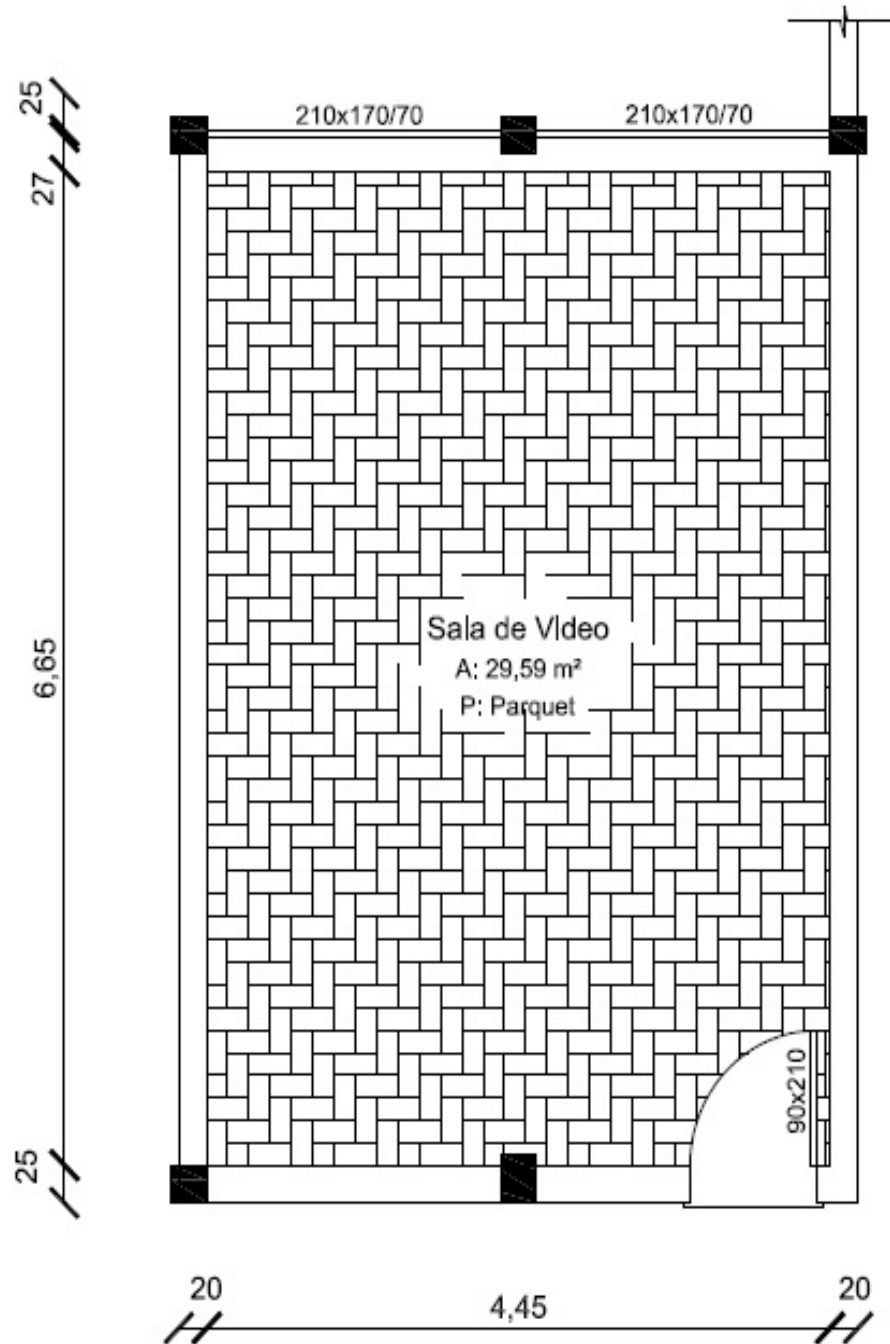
Planta baixa da sala de vídeo S4 (Nova escola)
